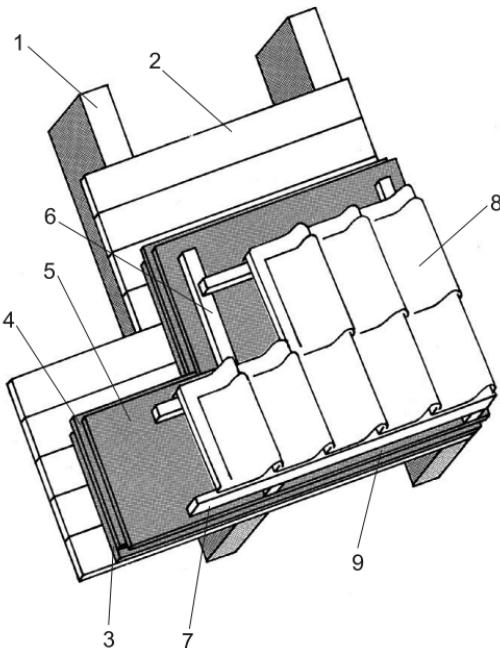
Теплоизоляция скатов крыши путем установки теплоизолирующего слоя над стропилами: 1 — стропила; 2 — внутренняя обшивка; 3 — пароизоляционная прокладка; 4 — утеплитель; 5 — подкровельная гидроизоляция; 6 — вертикальная обрешетка; 7 — горизонтальная обрешетка; 8 — кровельное покрытие; 9 — вентилируемый воздушный зазор
